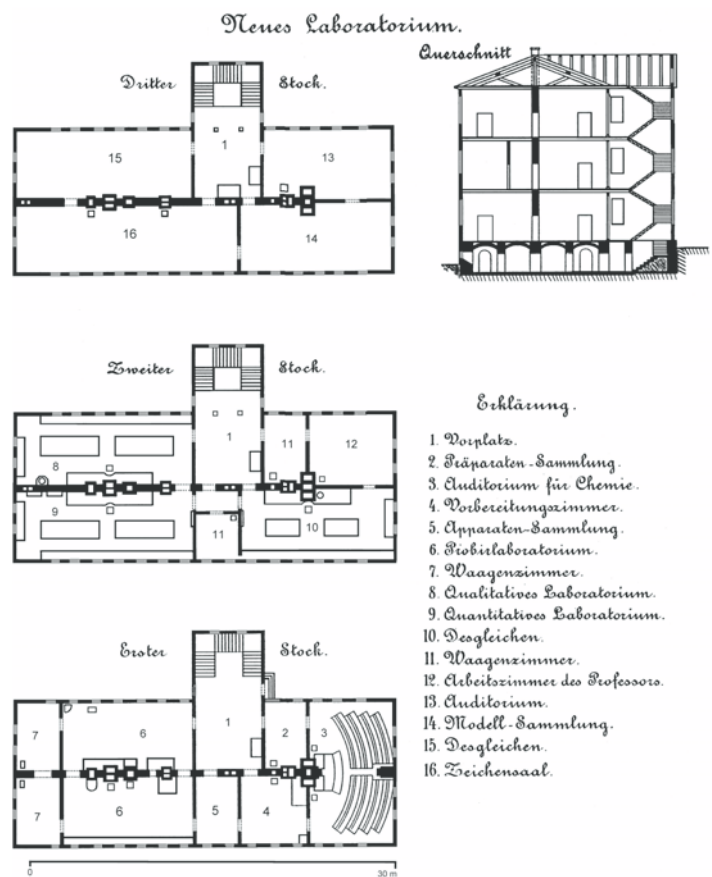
Grundriss des Chemischen Laboratoriums
